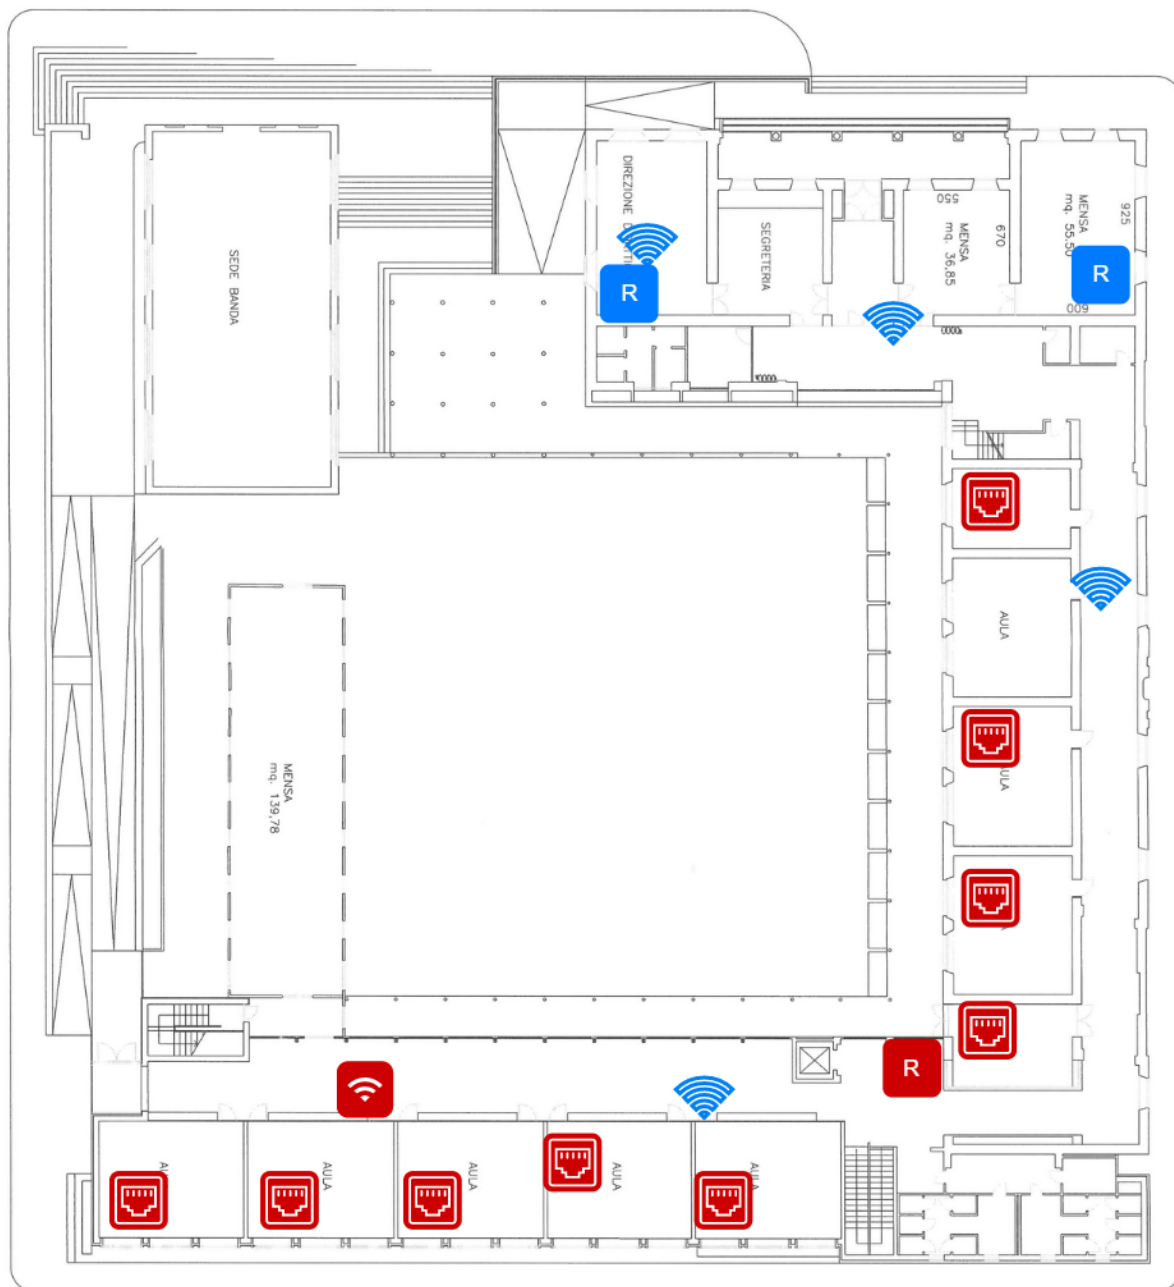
Planimetria Scuola Primaria "V. da Feltre" - Piano terra
